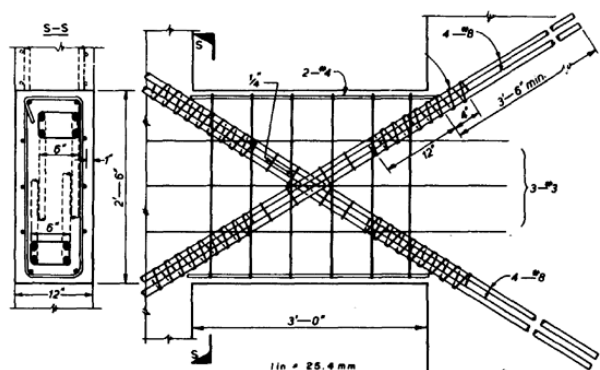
Armatura diagonale della trave di collegamento (Park e Paulay, 1975).
